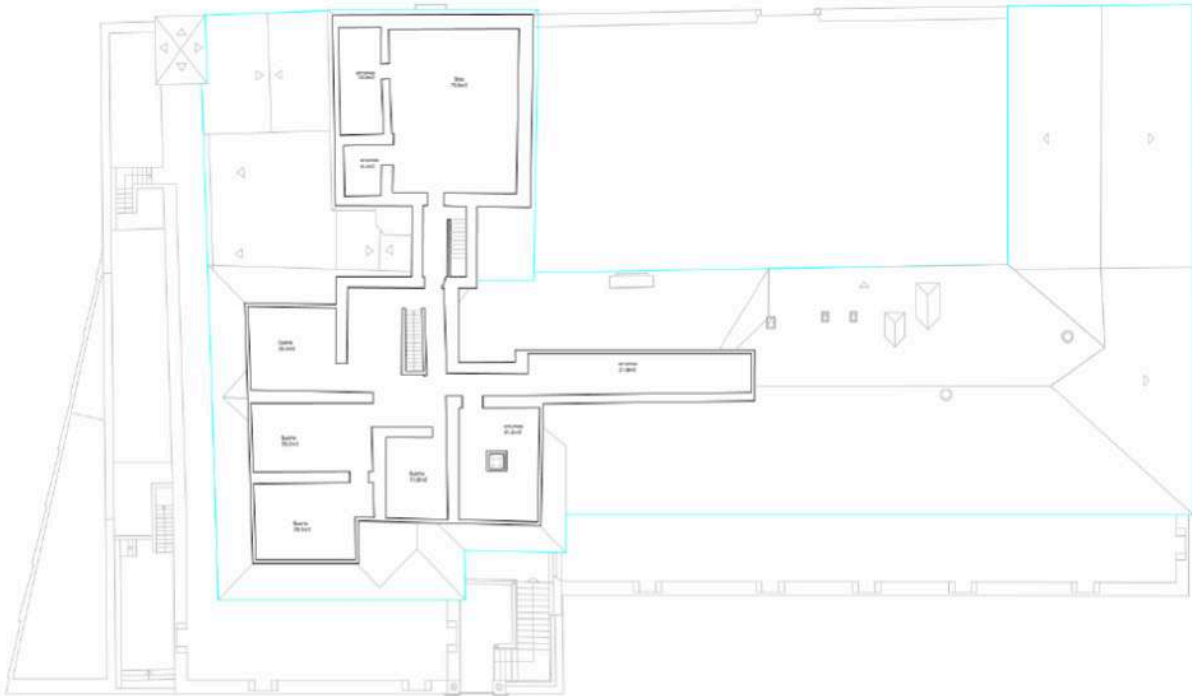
Planta original do piso 2 da Casa do Governador; sem escala
